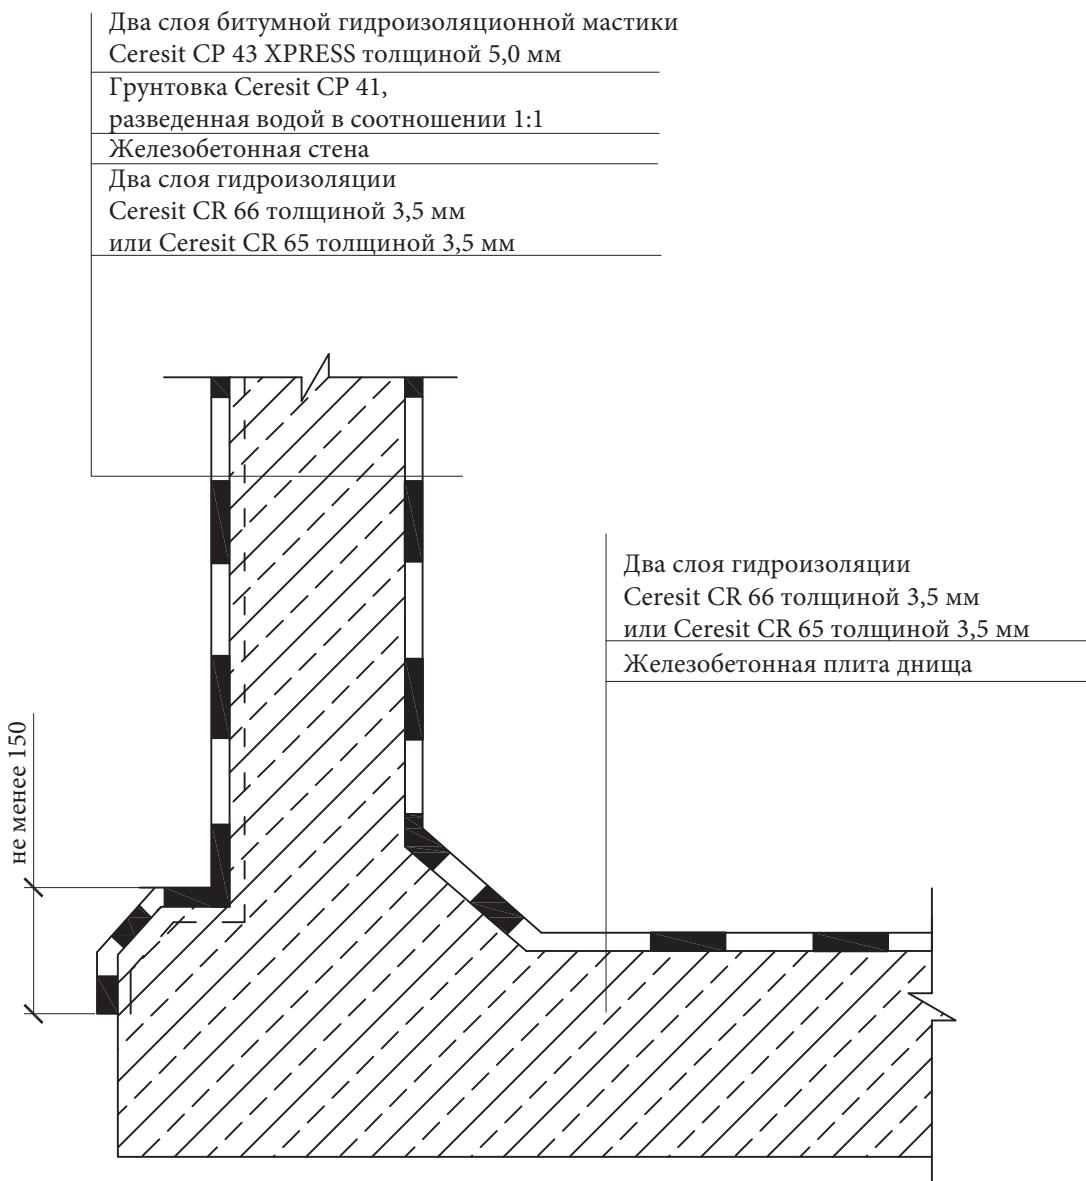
Конструкция системы гидроизоляции монолитных бетонных пожарных емкостей
